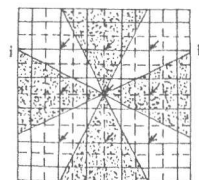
ひび割れ荷重までのスラブ変形状態図
